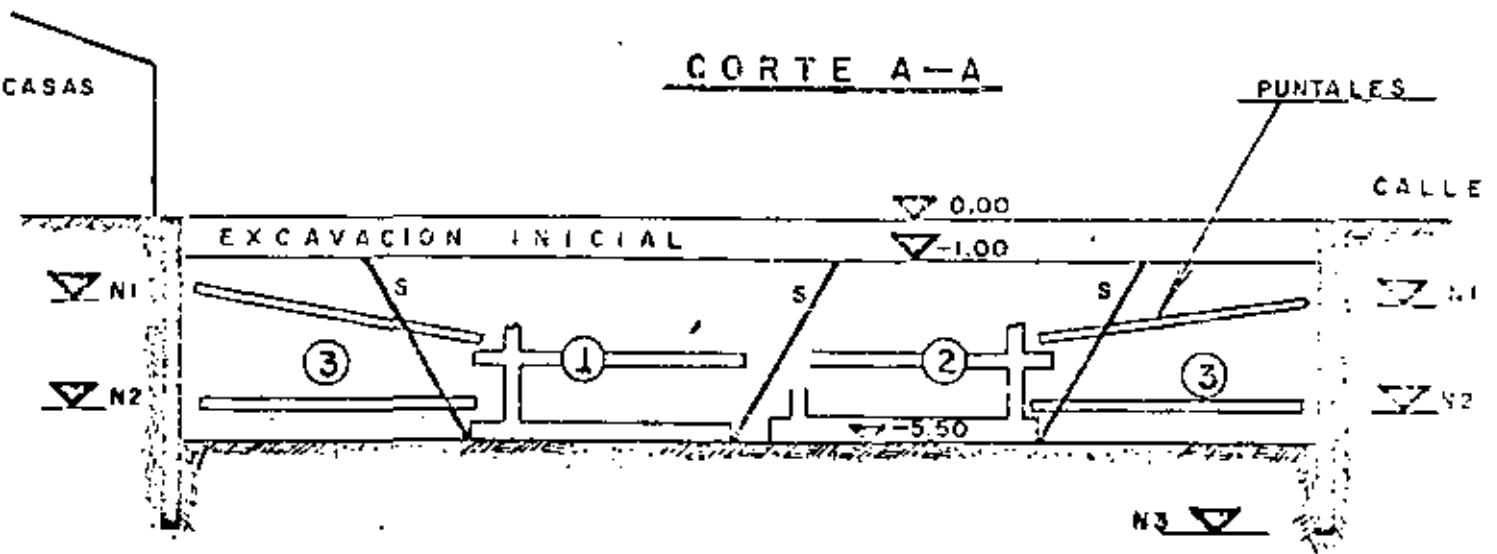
ETAPAS DE EXCAVACION Y PROCESAMIENTO CONSTRUCTIVO
